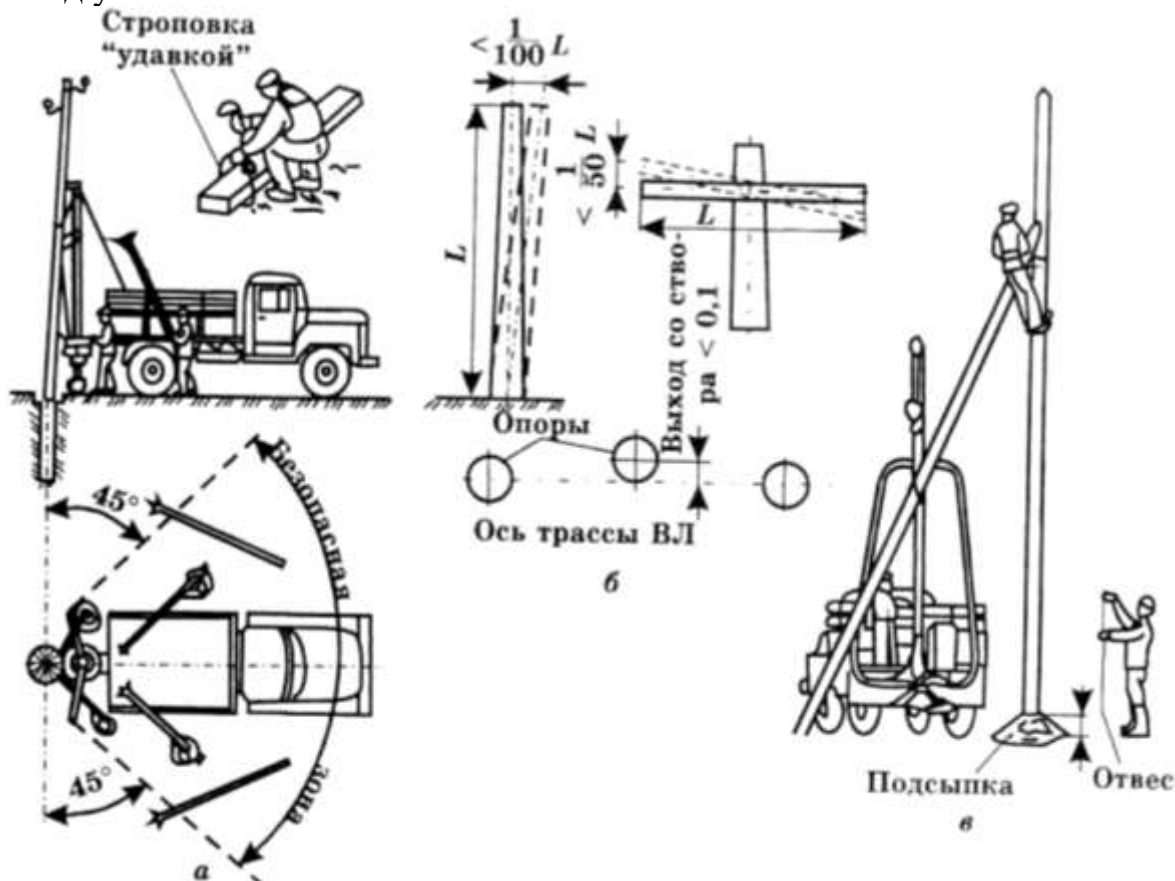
Монтаж опор: а — установка опоры; б — допустимые отклонения положения опоры и траверсы; в — установка подкоса
